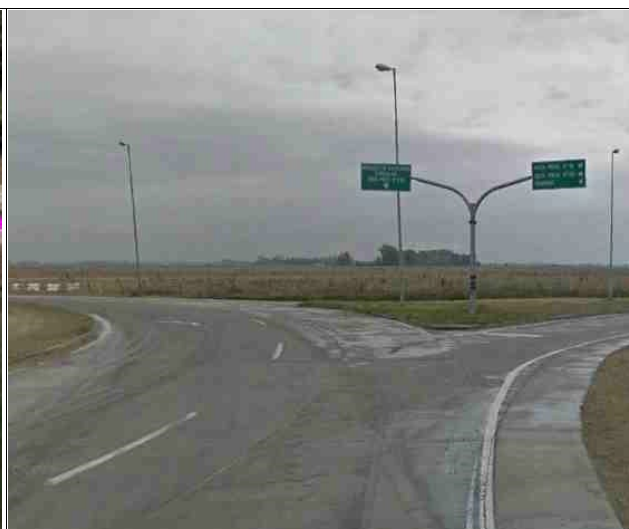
y Foto 209. Intersección RP N°6 con RP N°16
